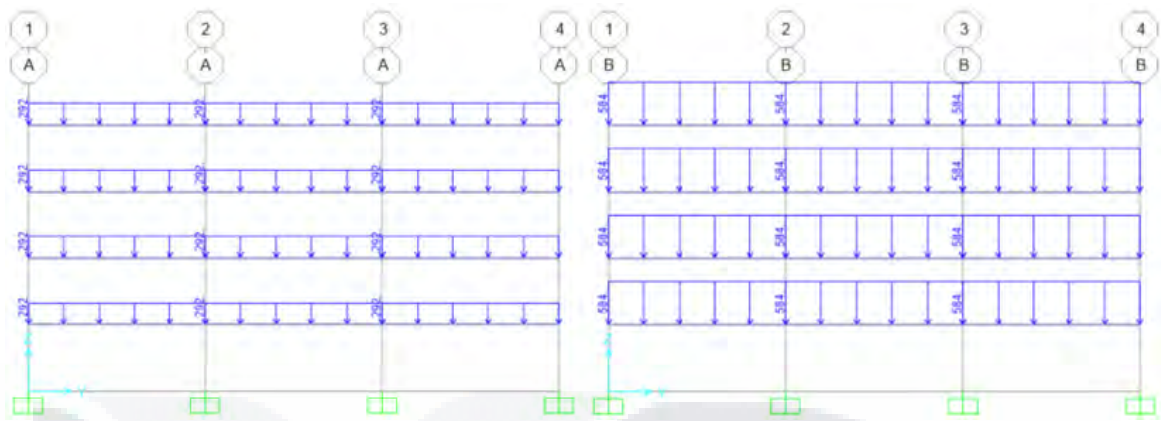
Sobrecarga muerta aplicada en eje A, Sobrecarga muerta aplicada en eje B (kg/m)
